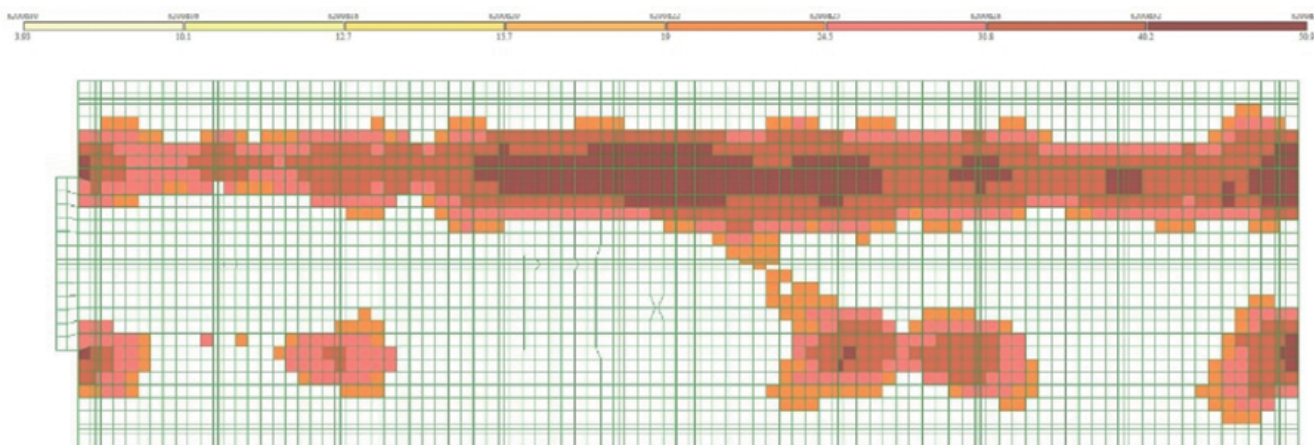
Армирование верхней грани вдоль оси Y (арматура А500С)
